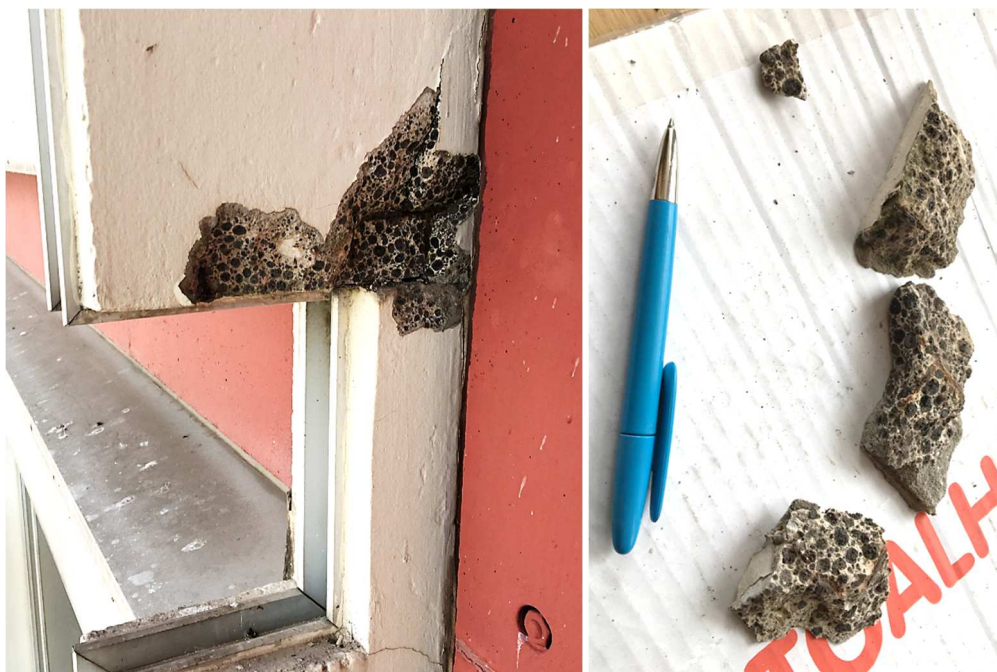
Fragmentos de betão removidos de um elemento vertical pré-fabricado da fachada poente
